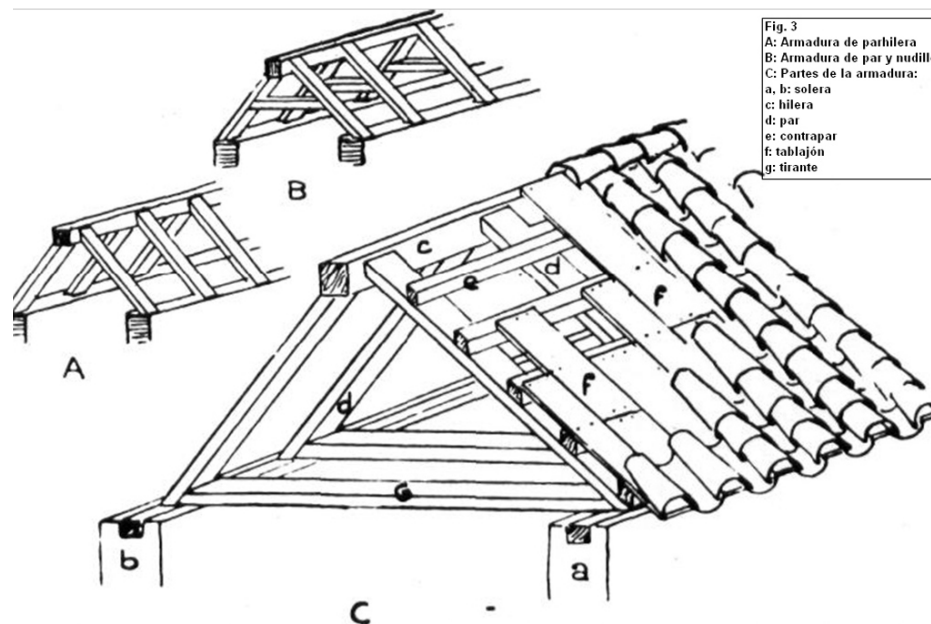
Esquema de la armadura de parhilara y cubierta de teja.
